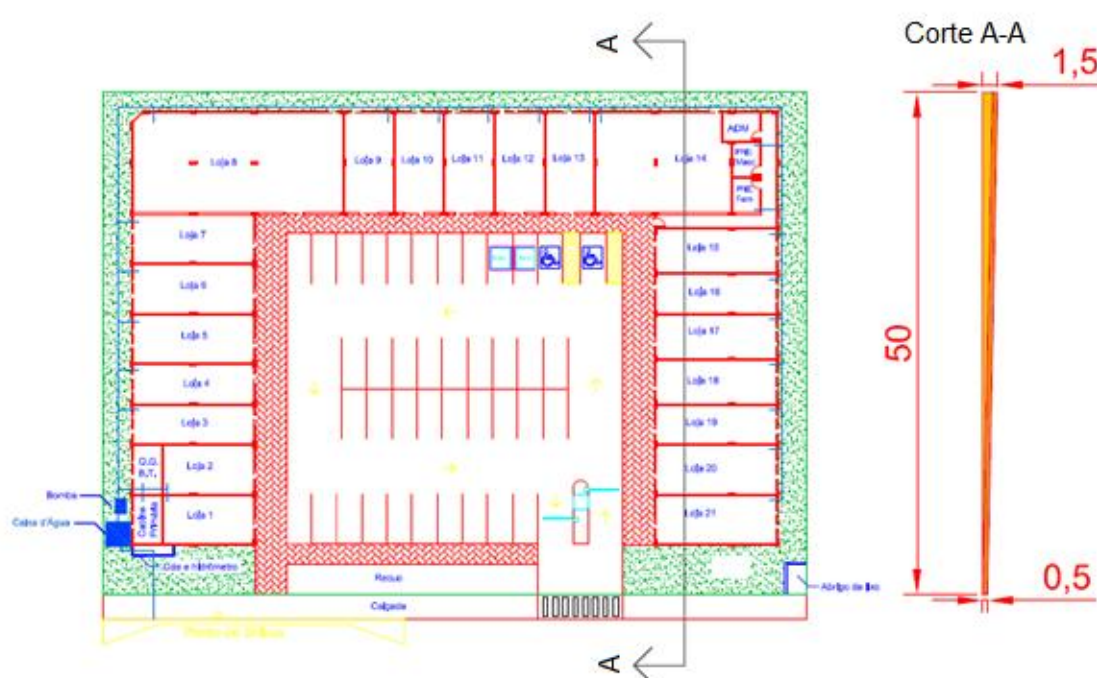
Planta do Strip Mall e perfil de corte e aterro
